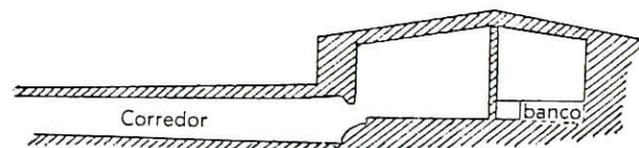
Plano transversal da casa de Angmagssalik (H.B.)
